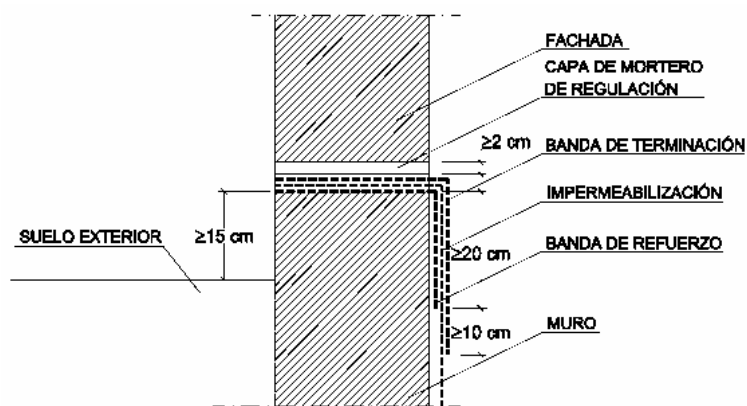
Ejemplo de encuentro de un muro impermeabilizado por el interior con lámina con una fachada
